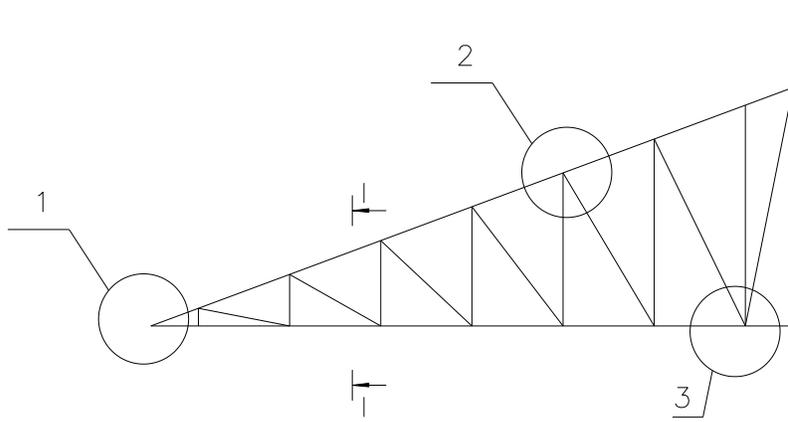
Схема типовых узлов соединения элементов стропильных ферм.
